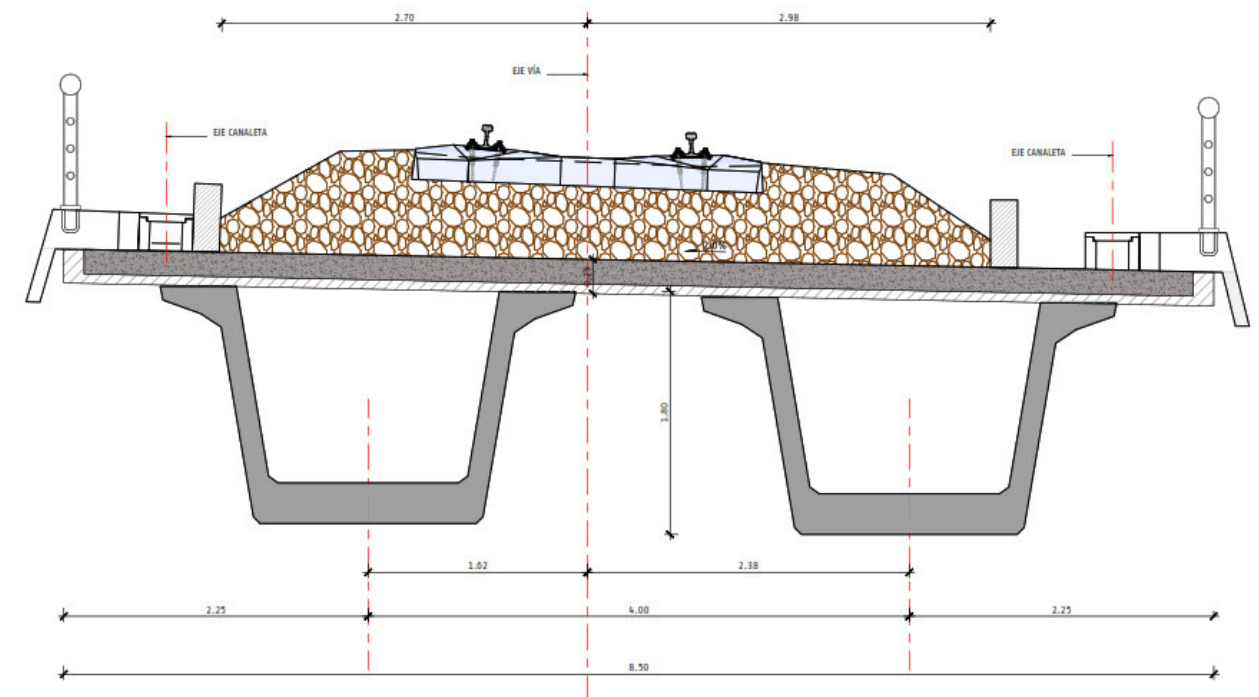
Sección transversal Vdto. Arroyo de las Salinas.
